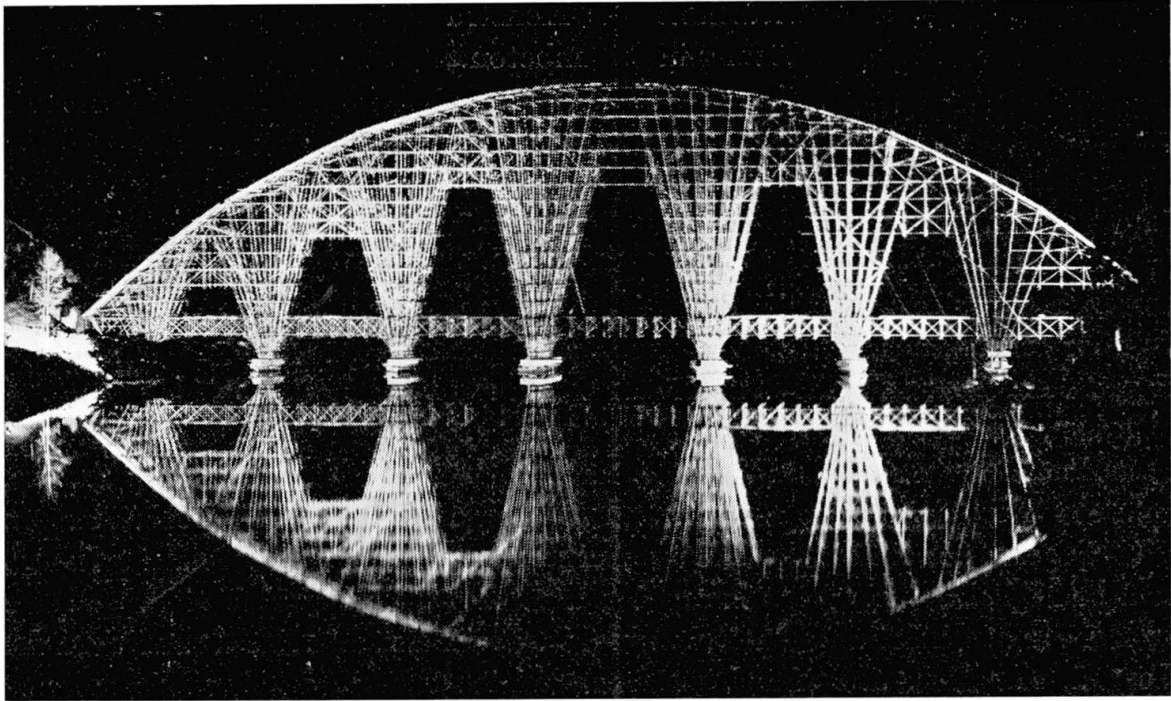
Rheinbrücke bei Reichenau; Lehrgerüst.
